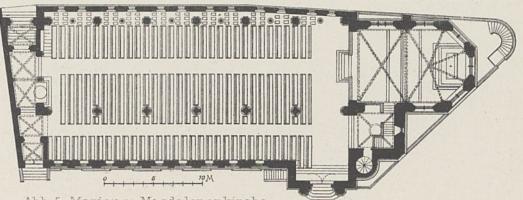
Marien u. Magdalenenkirche in Paddington, London. Architekt G.E. Street.
